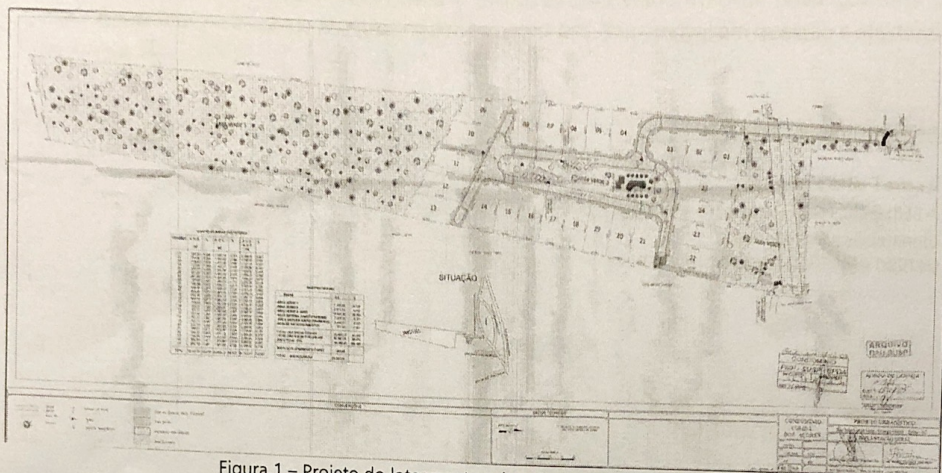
Projeto do loteamento existente no arquivo da SMDU.
